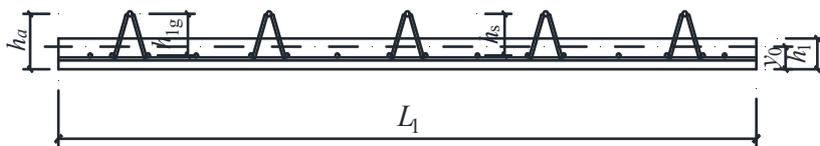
钢筋桁架混凝土预制底板板带组合截面示意（垂直桁架方向）
